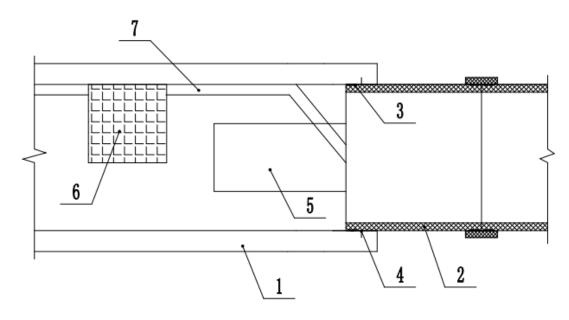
竹缠绕管廊廊体与混凝土节点连接平面示意图
